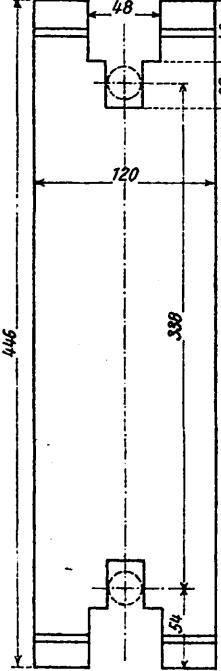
Stuhllasche auf einer Mittelschwelle. Grundriß. Maßstab 1:5.
